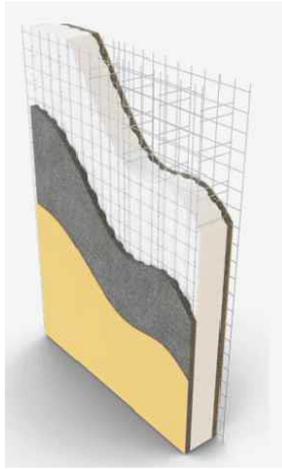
Panel –mallas tridimensionales de alambres de acero soldados y un núcleo de poliestireno expandido (EPS) compuestos en fábrica más dos capas exteriores de hormigón proyectado. (Ejemplo).
